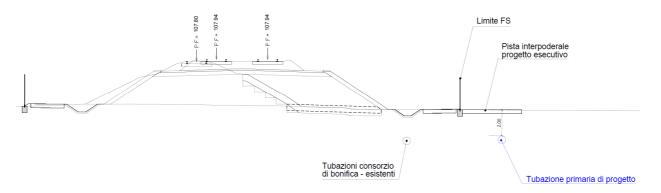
Spostamento tubazione - Sezione tipo tubazione primaria
